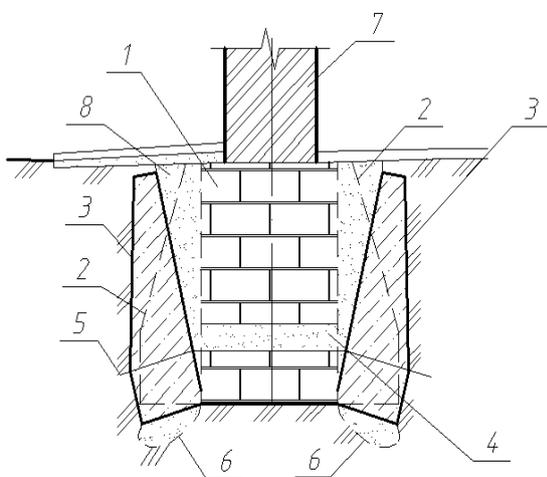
Уширение опорной площади ленточных фундаментов установкой сборных железобетонных элементов: 1 – усиливаемый фундамент; 2, 3 – элементы уширения соответственно до и после раздвижки; 4 – отверстие, заделываемое жидким цементным раствором под давлением; 5 – анкер; 6 – зоны уплотненного грунта; 7 – кирпичная стена; 8 – бетон из мелкого заполнителя
